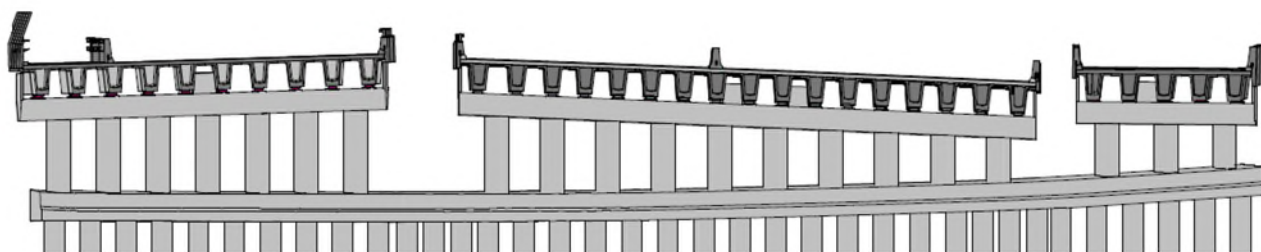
Sección esquemática por pila de los 3 puentes sobre Kempston Street.
